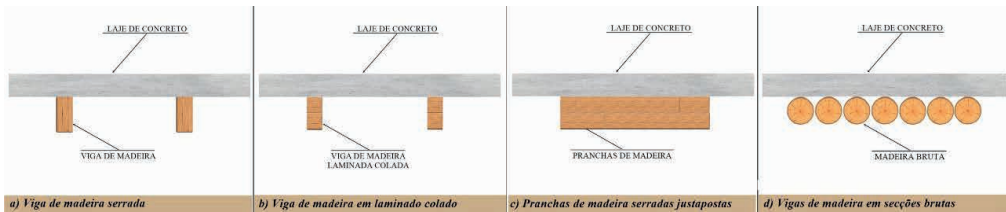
Detalhe de seções mistas em concreto/madeira
